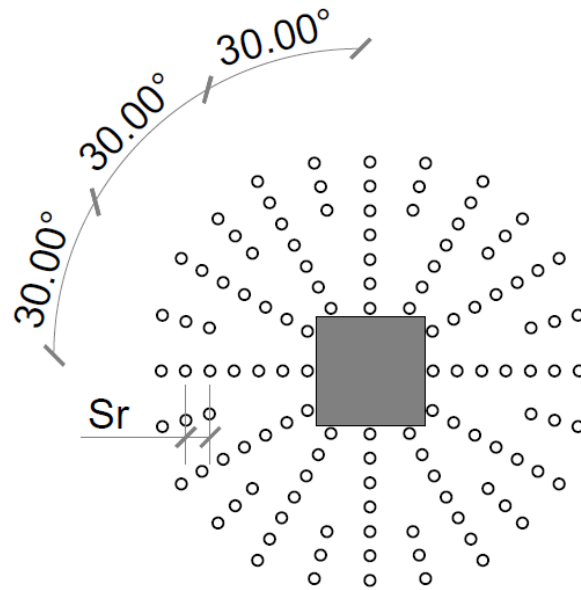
Detalhe da armadura de cisalhamento das lajes compostas por sete camadas de *studs
